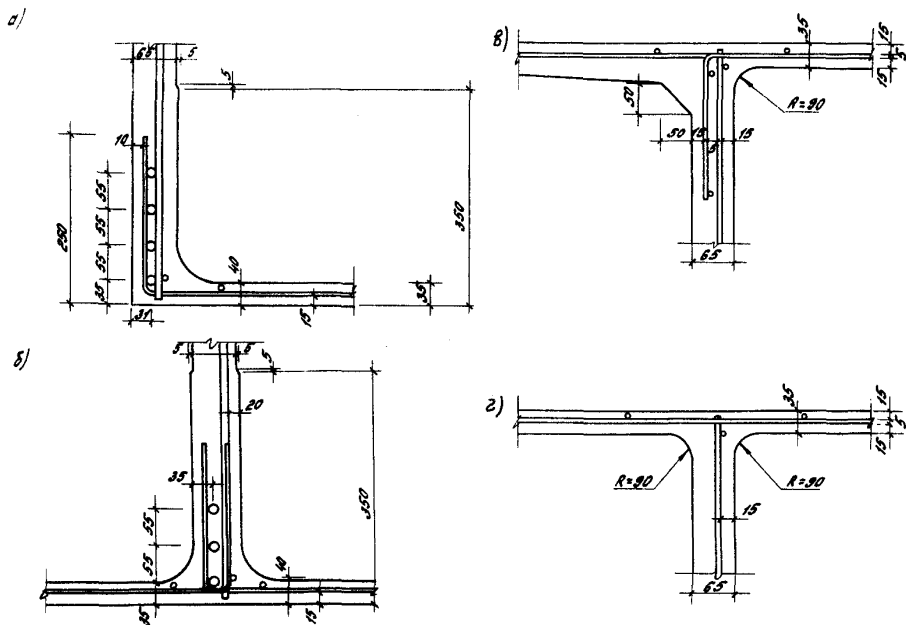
Схема размещения арматуры в поперечном сечении нижней (а,б) и верхней (в,г) зоны коробчатого настила
